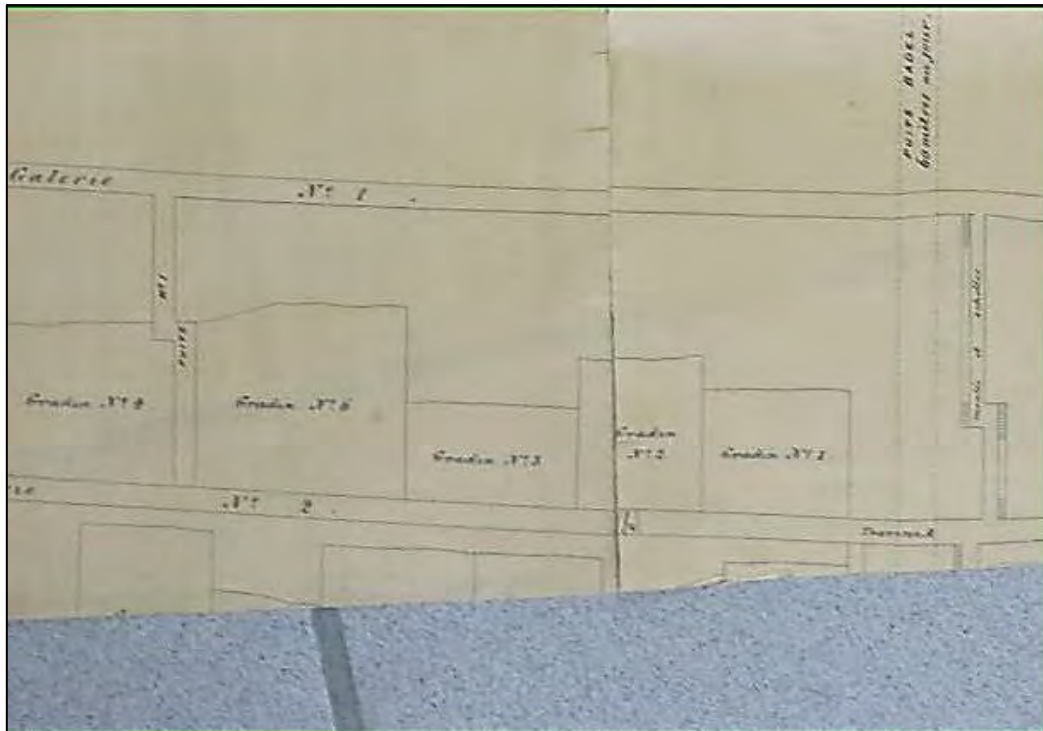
Coupe partielle des travaux de Grézolles (extrait plan 10)
